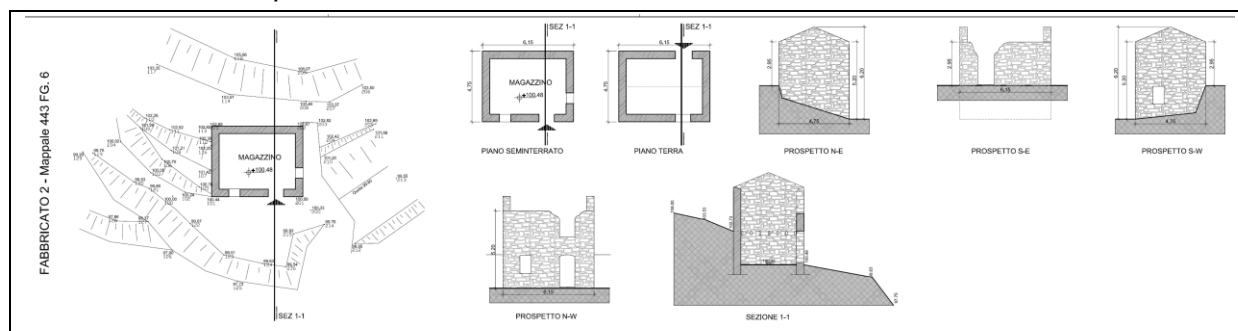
Stato attuale da progetto autorizzato con PdC 896/2021
